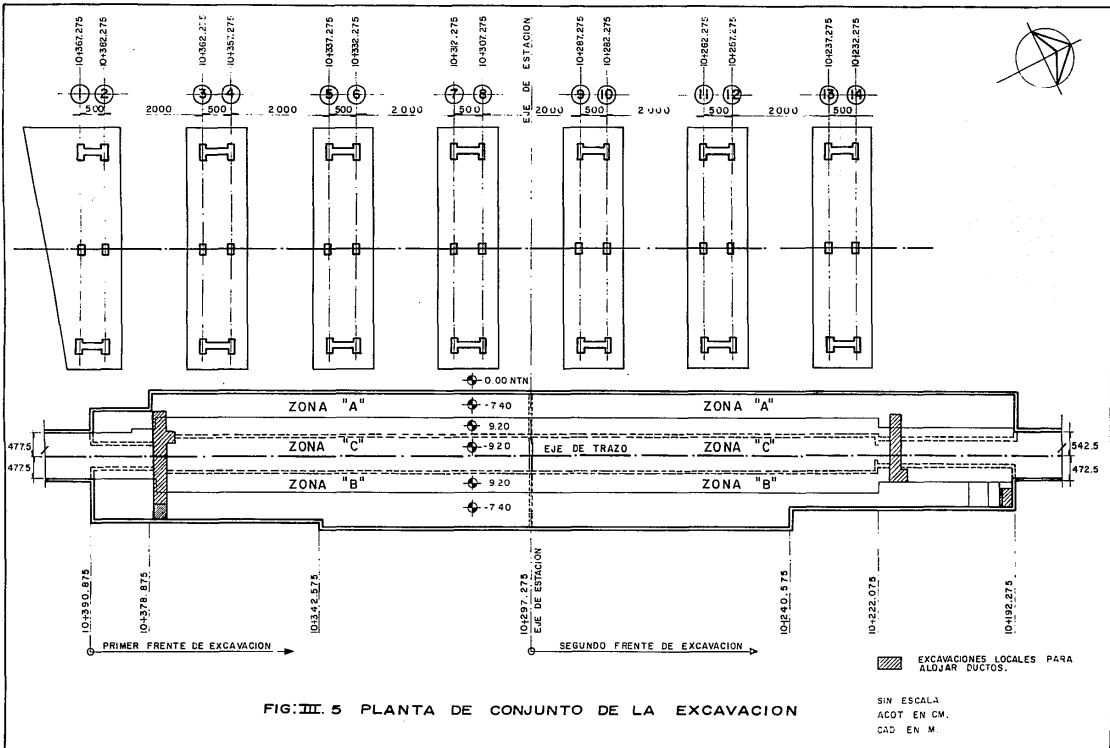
PLANTA DE CONJUNTO DE LA EXCAVACION
